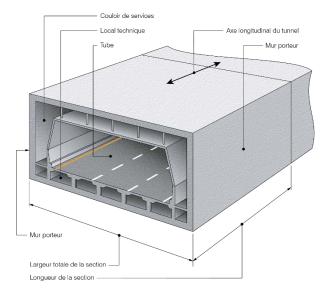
Largeur totale d'une section de tunnel constituée d'un seul tube
